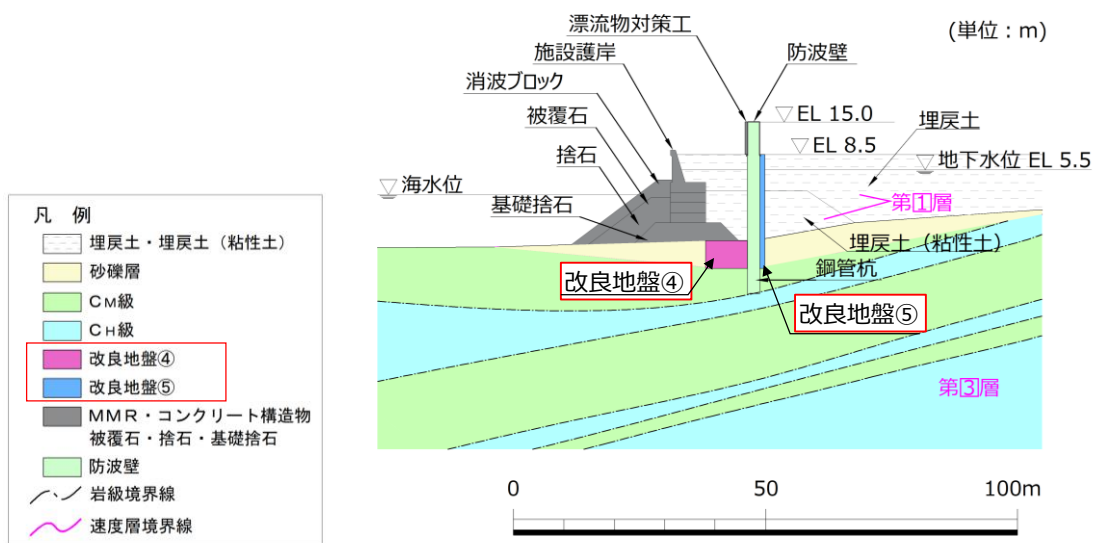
改良地盤④及び改良地盤⑤の配置図
